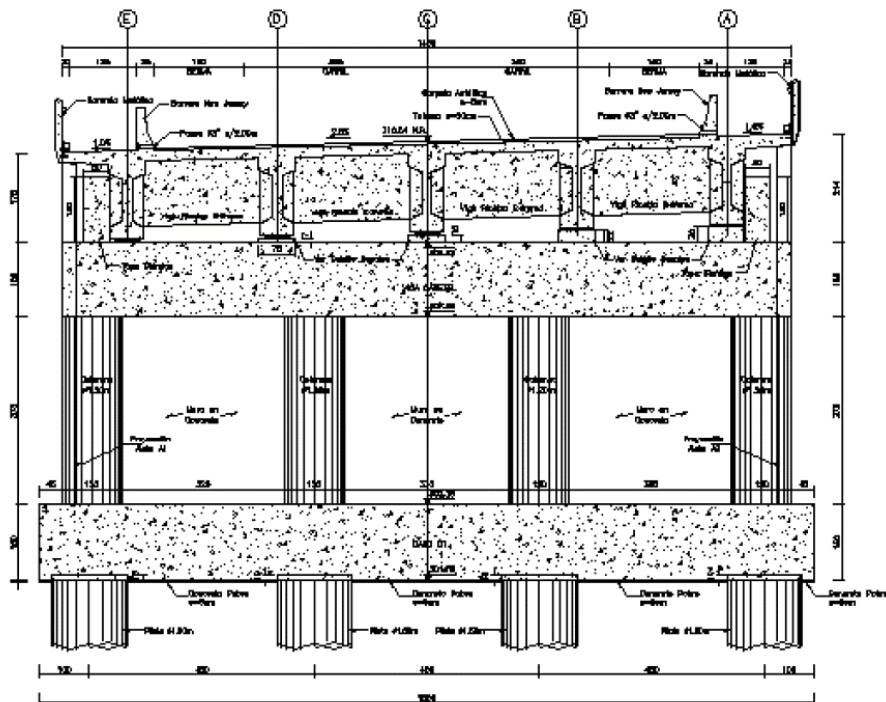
Geometría del apoyo eje 1 puente San Pedro.
